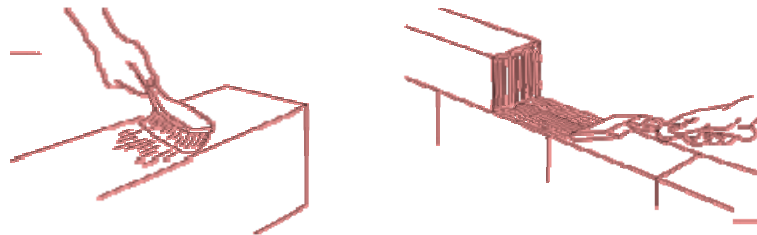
Limpieza y colocación de adhesivo sobre los bloques de Retak.
